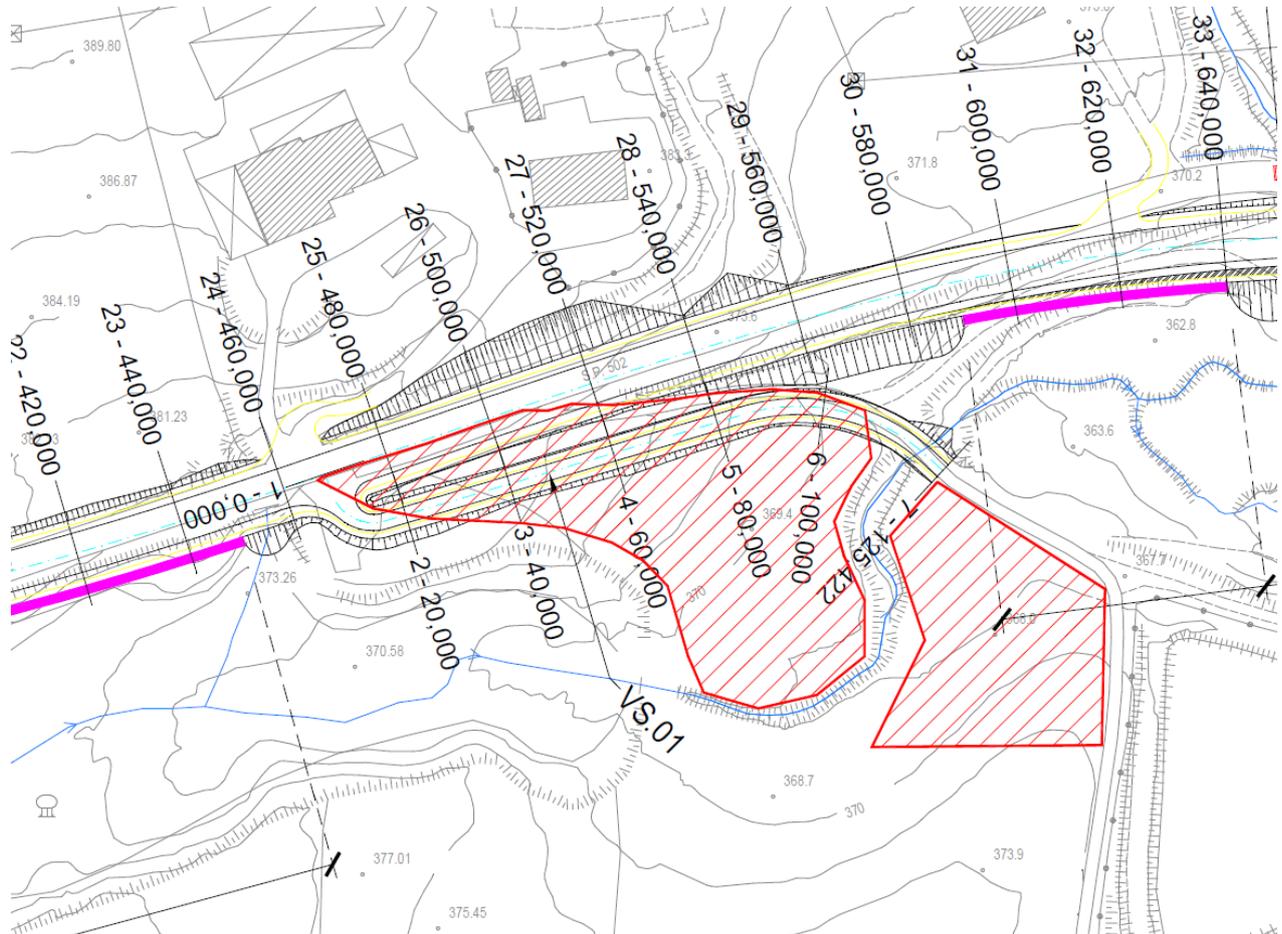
Disposizione delle aree cantiere (in rosso)
